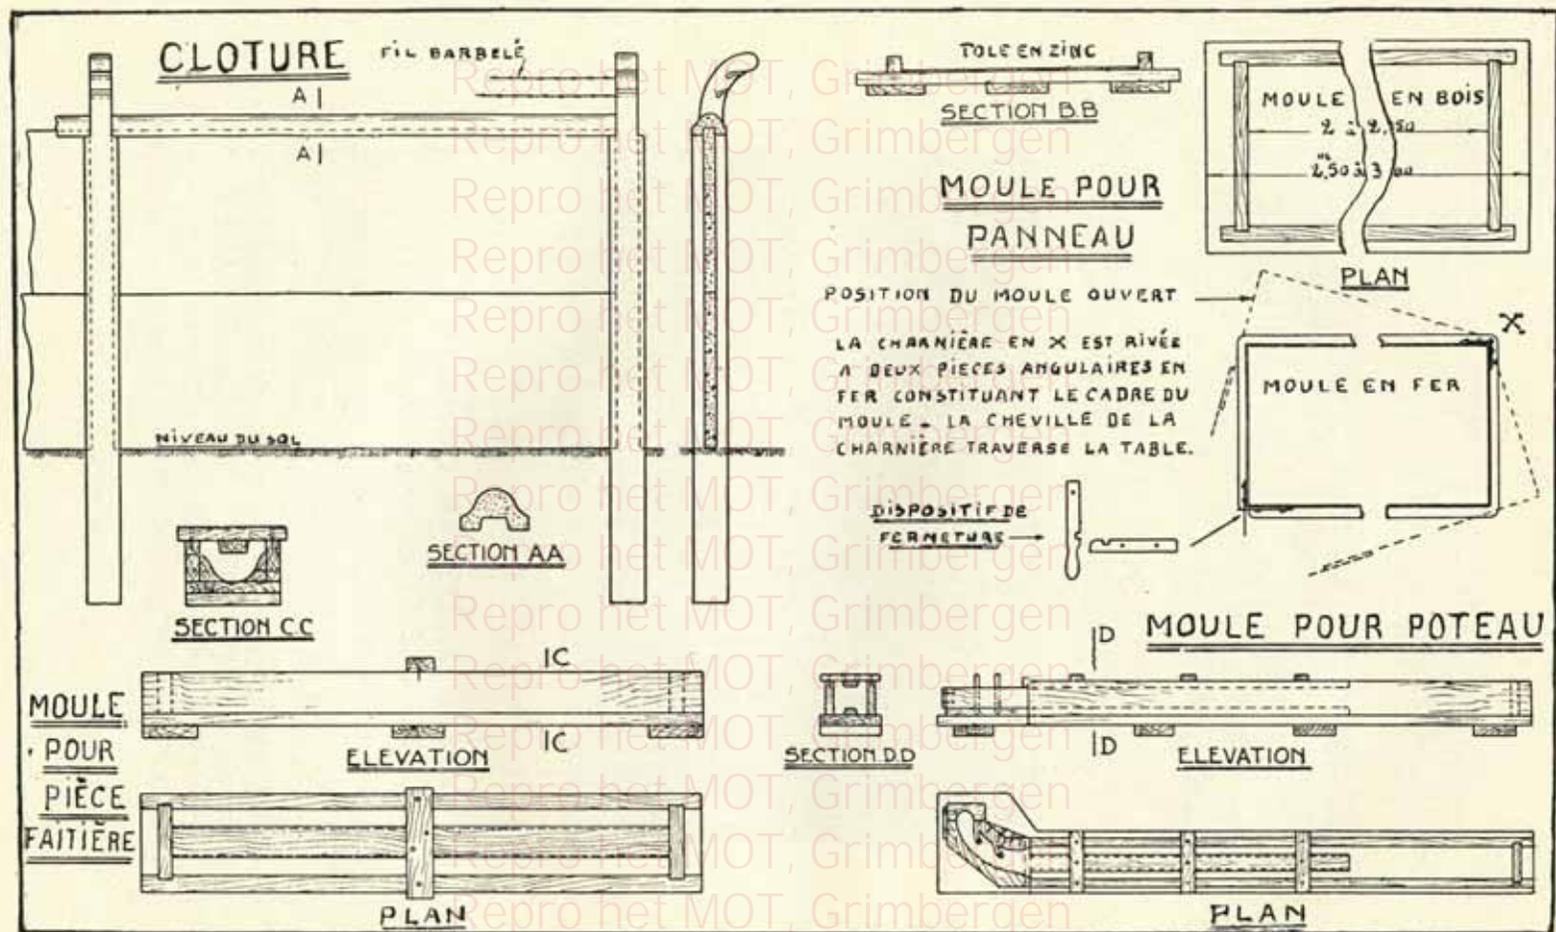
Clôture composée de poteaux et panneaux en béton.
